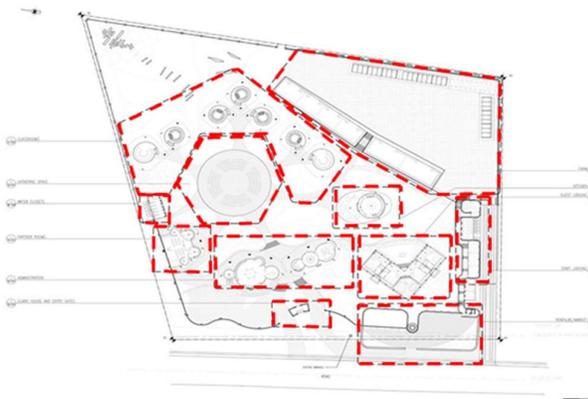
Primera planta del Centro de Oportunidades para la Mujer en
